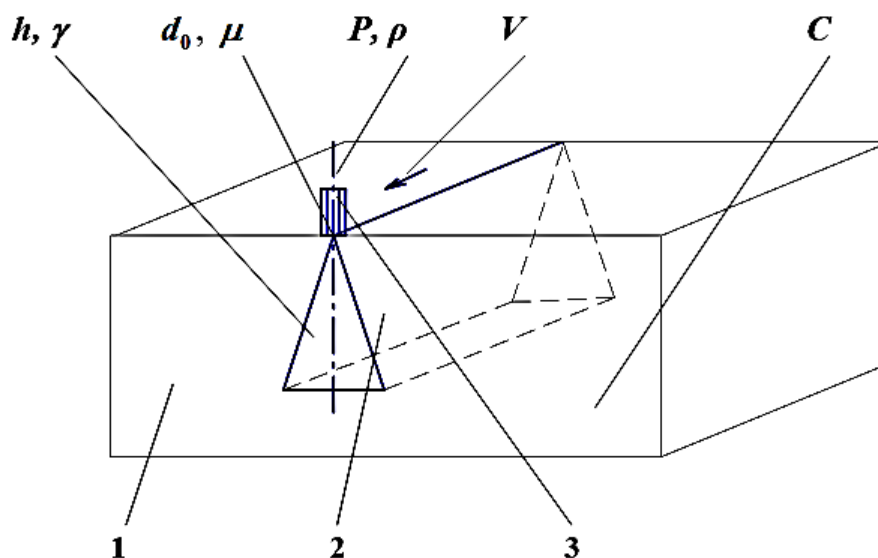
Схема ГСЦ дорожного полотна: 1 – закрепляемое полотно; 2 – породобетон; 3 – струеформирующая насадка; h – глубина цементации, м; γ – угол при вершине породобетонного массива, град; d_0 – диаметр струеформирующей насадки, м; μ – коэффициент расхода через струеформирующую насадку; P – давление цементного раствора, МПа; ρ – плотность водоцементной суспензии, кг/м³; V – скорость перемещения струеформирующей насадки, м/с; C – коэффициент сцепления горной породы, Мпа
